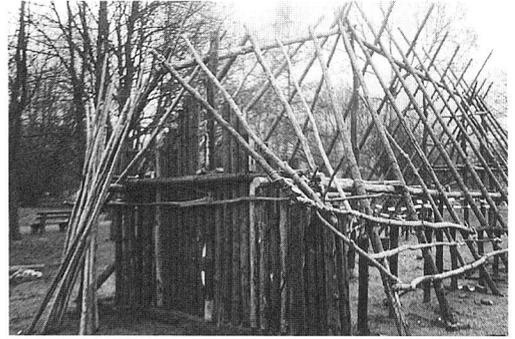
N-W-Giebelwand mit Dachkonstruktion (Traufhölzer TP = 1,58 m).
